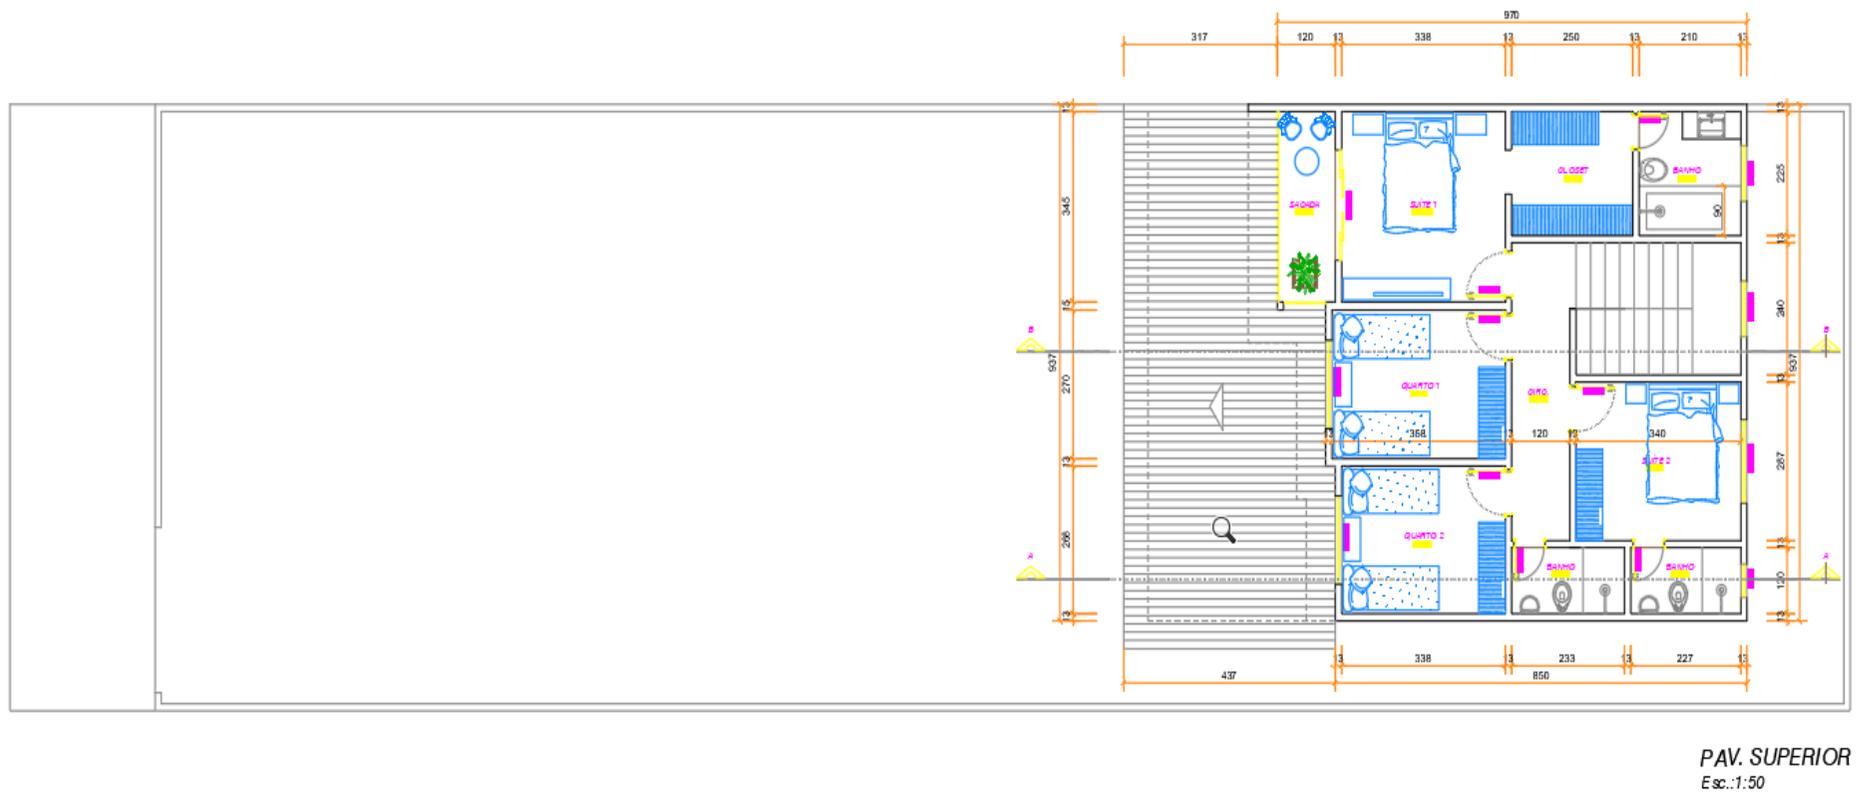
Planta Pavimento Superior Projeto Arquitetônico
